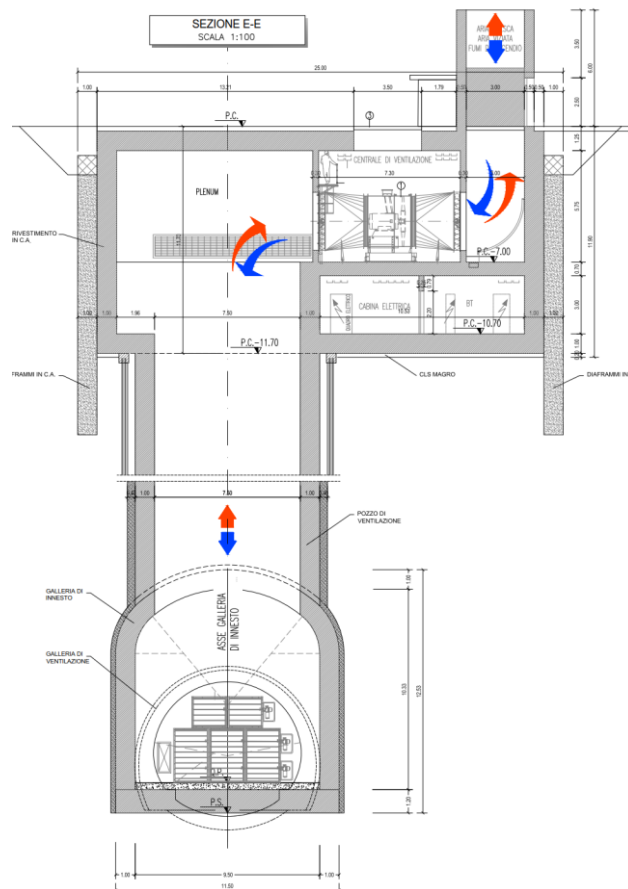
Sezione di dettaglio dei pozzi di ventilazione
